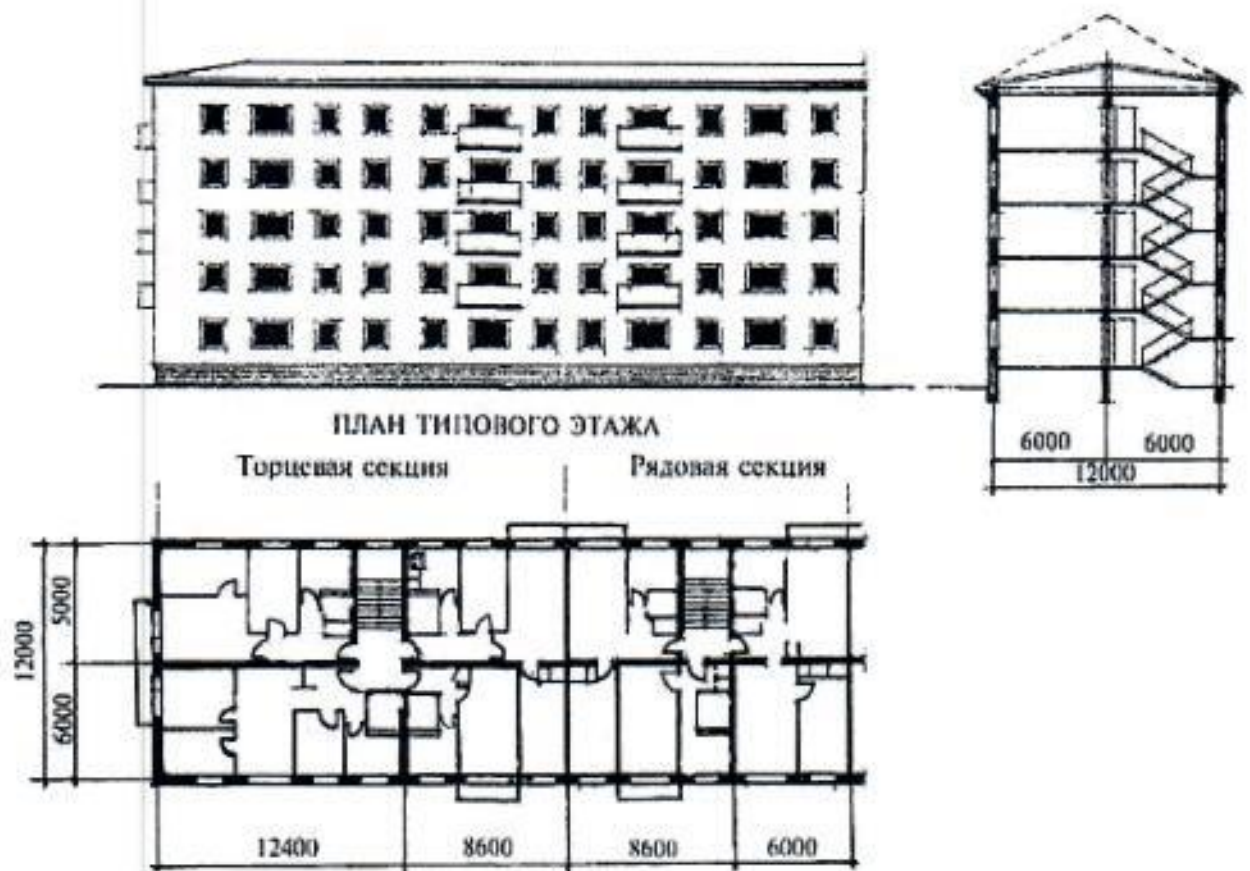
Фасад, план типового этажа и разрез жилых домов с кирпичными стенами серии I-447
